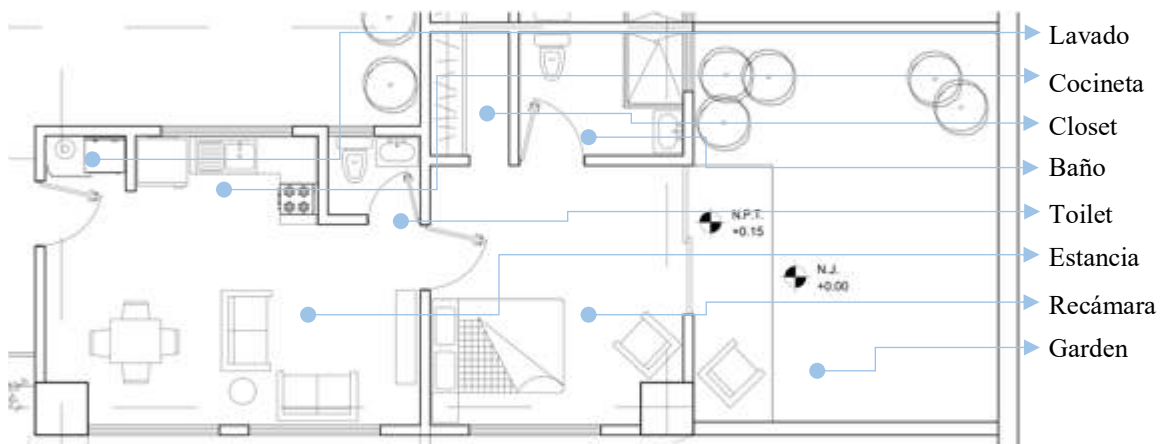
Departamento tipo, planta baja. Fuente: Elaboración propia.
